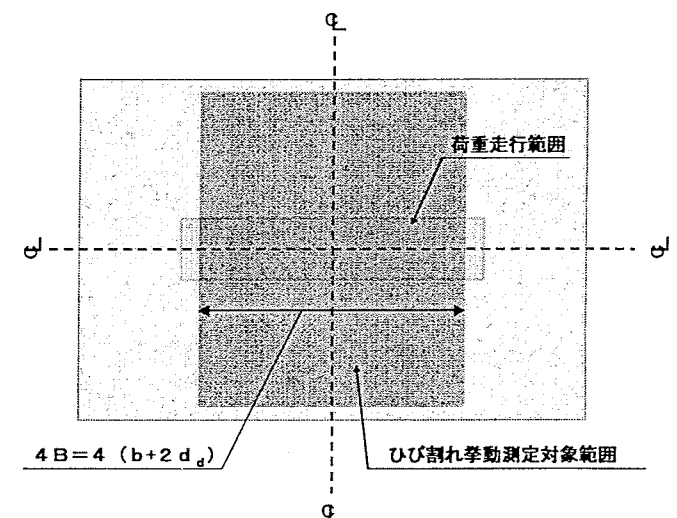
ひび割れの開閉量・段差発生量
